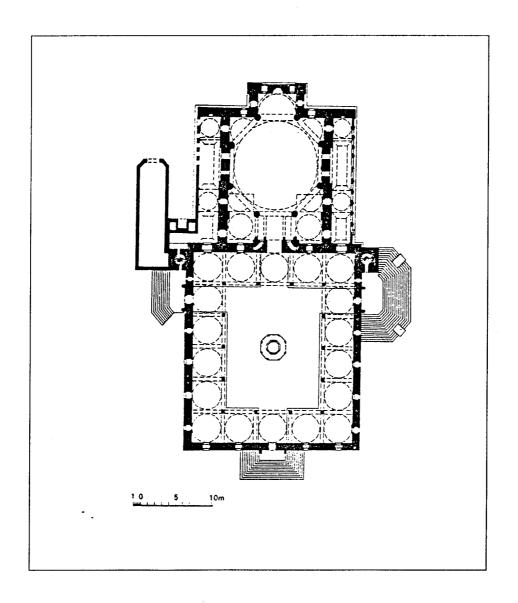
مسقط أفقي لمسجد السليمية في إستانبول (عن : جابرييل) .
